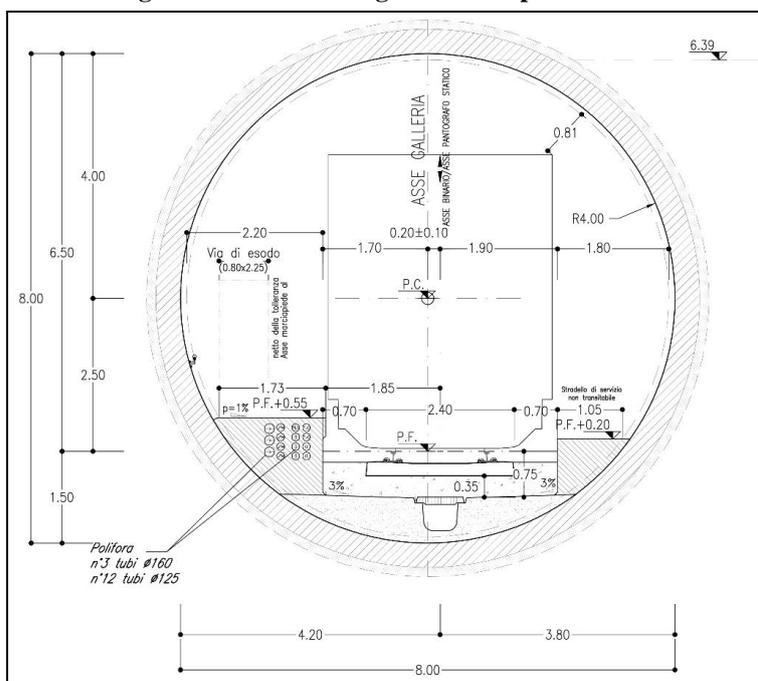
Sezione di intradosso galleria di linea a singolo binario in scavo meccanizzato (sezione corrente)
